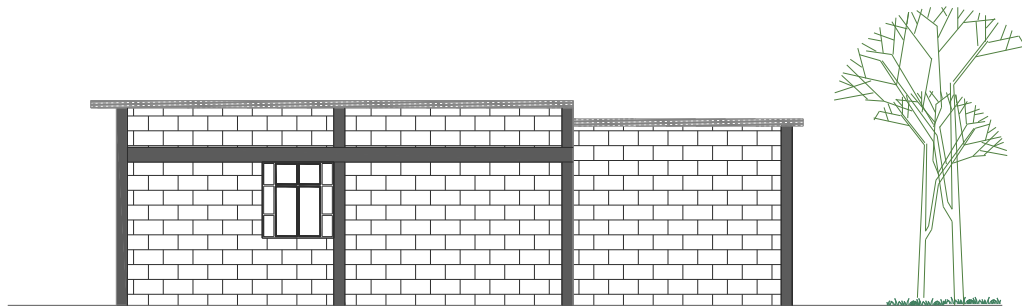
Fachada Lateral Norte – F2. Fuente: Elaboración propia.
